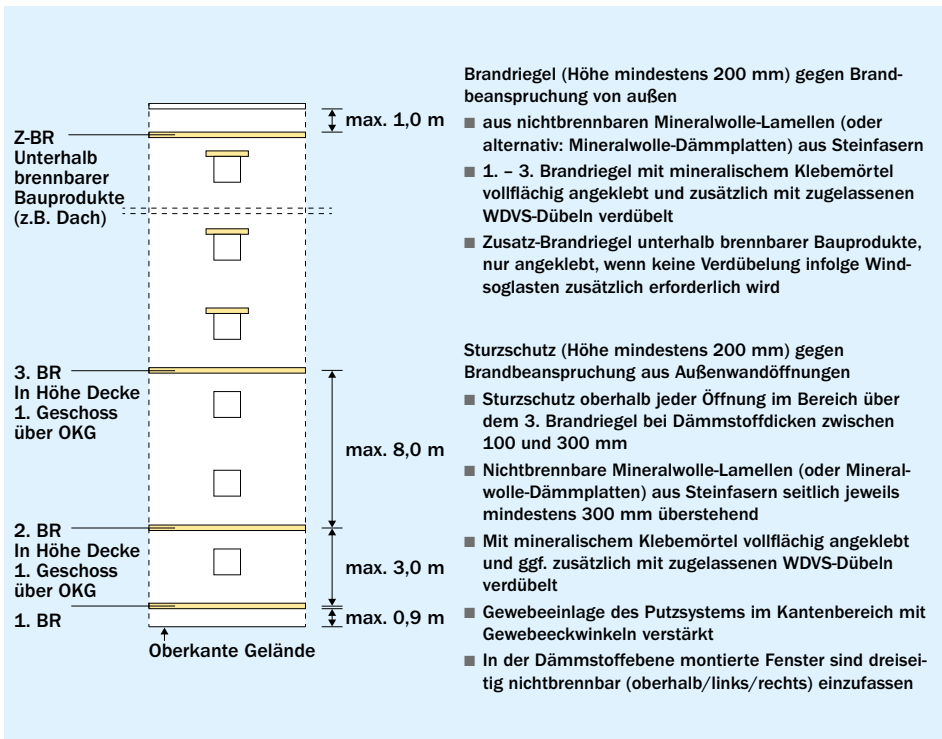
Schwerentflammbare WDVS mit EPS ($d \leq 300$ mm) – Ausbildung mit umlaufenden Brandriegeln sowie Schutz der Fensteröffnungen
